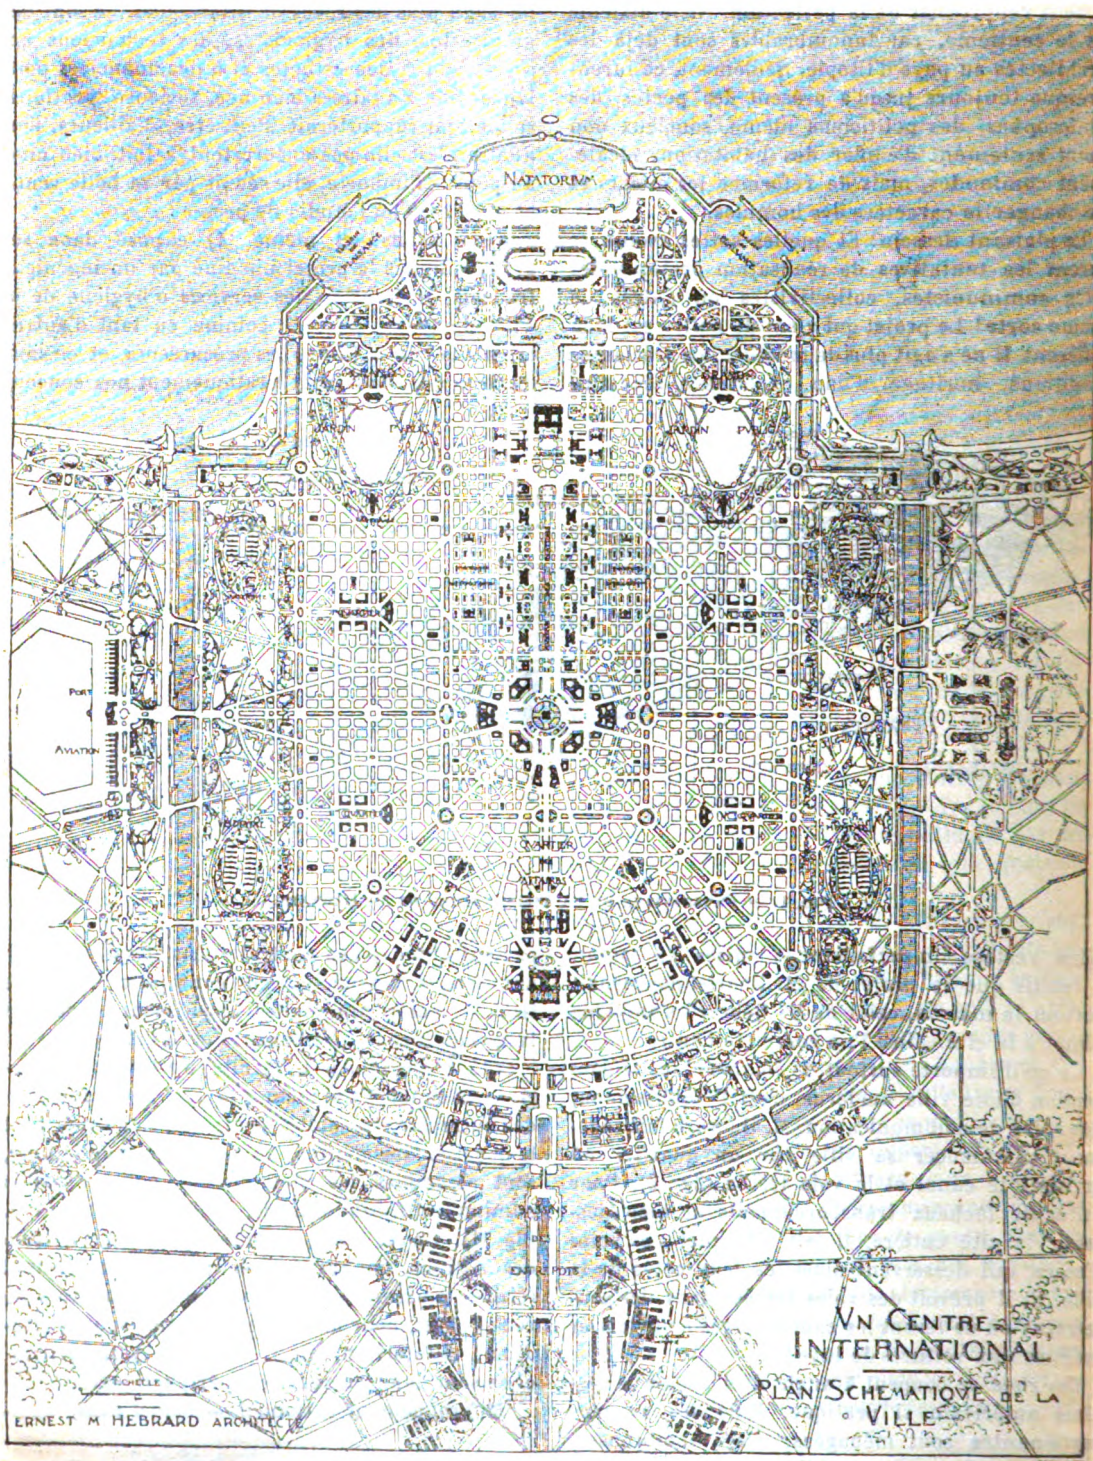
PLAN SCHEMATIQUE DE LA CITÉ FUTURE, DRESSÉ PAR M. HÉBRARD, ARCHITECTE.
